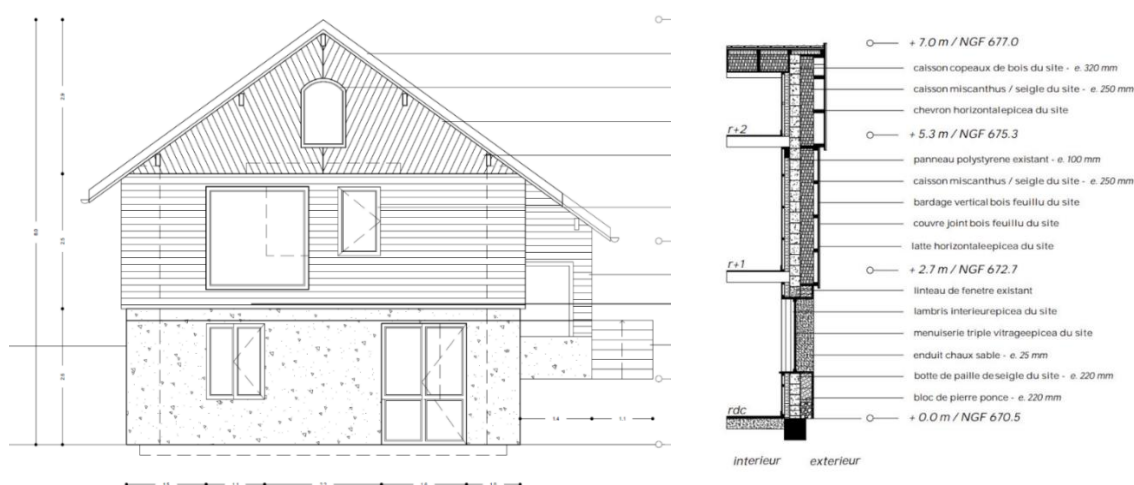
Démonstrateur Pavillon 81 : coupe de façade avec composition des matériaux isolants biosourcés
